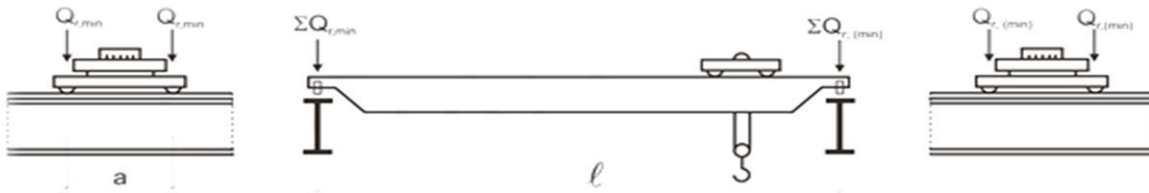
Dispositions de charge de l'appareil de levage à vide pour obtenir un chargement minimal sur la poutre de roulement
